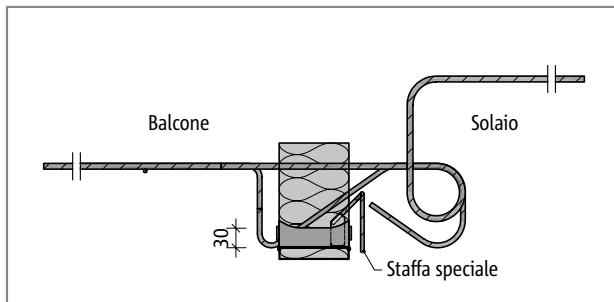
Schöck Isokorb® tipo KXT65-HV: sezione dell'elemento
